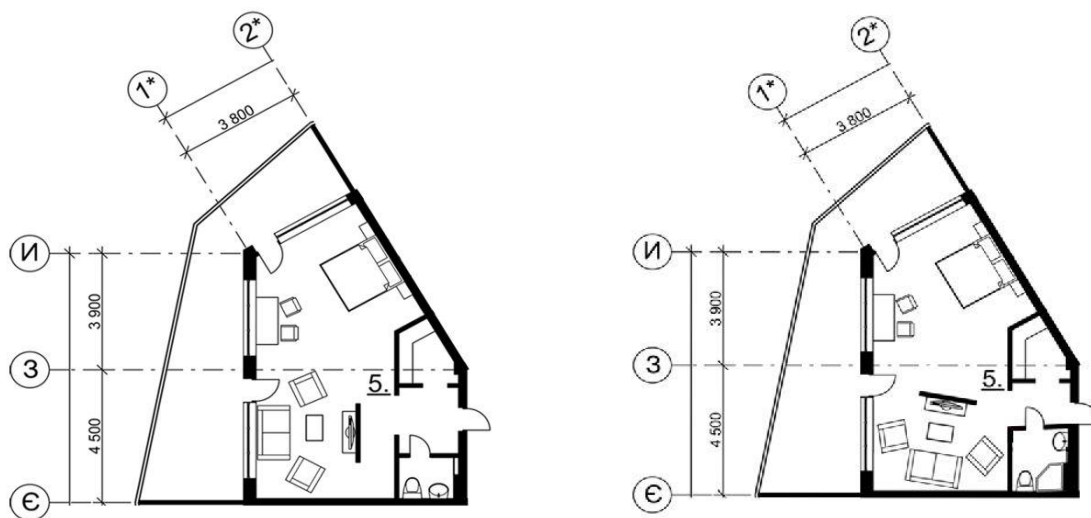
креслення плану номеру 1-ї категорії двомісний із розташуванням меблів; 4.3.3 – креслення номеру із переплануванням.
